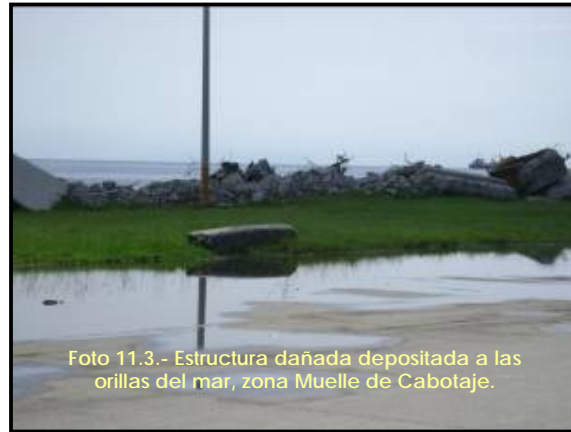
Estructura dañada depositada a las orillas del mar, zona Muelle de Cabotaje.
